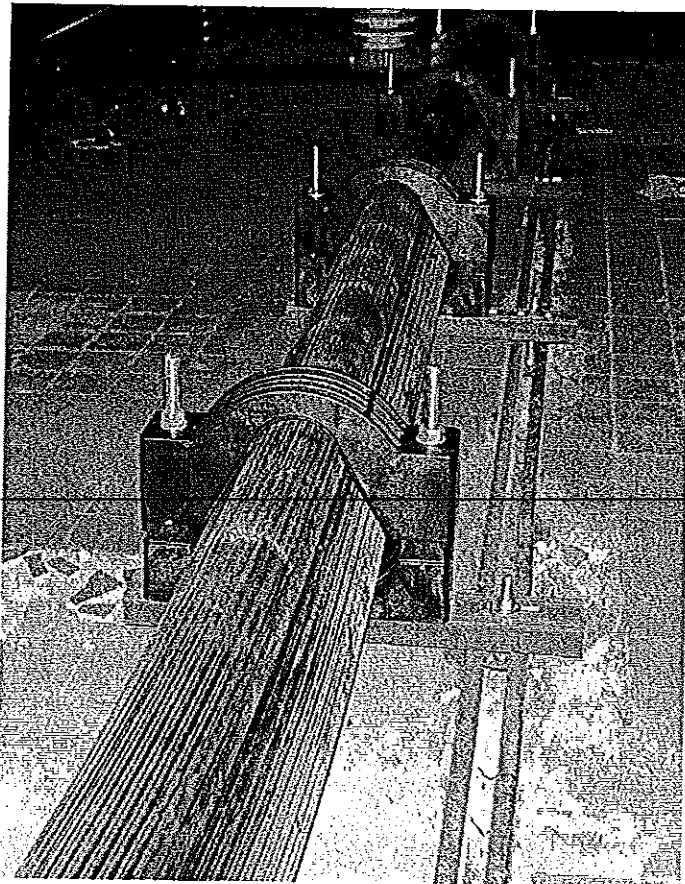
Крепление кабелей в треугольник на поперечных подставках, закрепленных на полу, с помощью хомутов (скоб) из армированного полиамида
